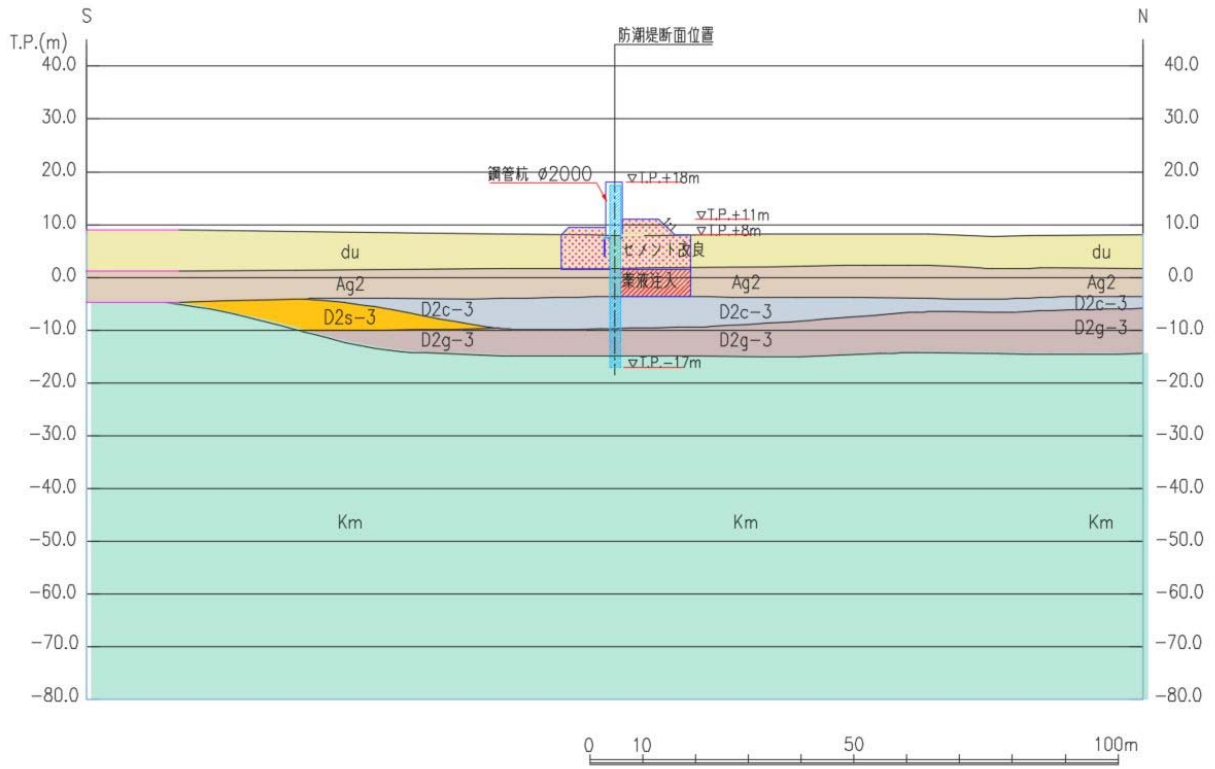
11. 5-21 (1) 鋼管杭鉄筋コンクリート防潮壁 断面図 (断面①)
